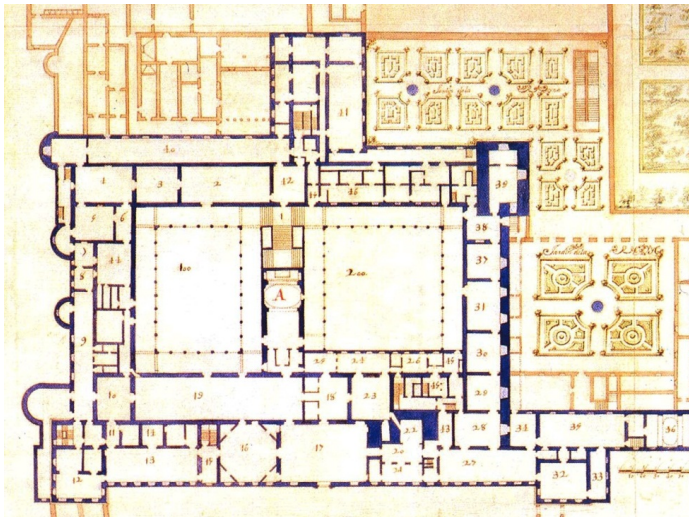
Teodoro Ardemans. Planta Principal del Alcázar.1705. Biblioteca Nacional. París.
